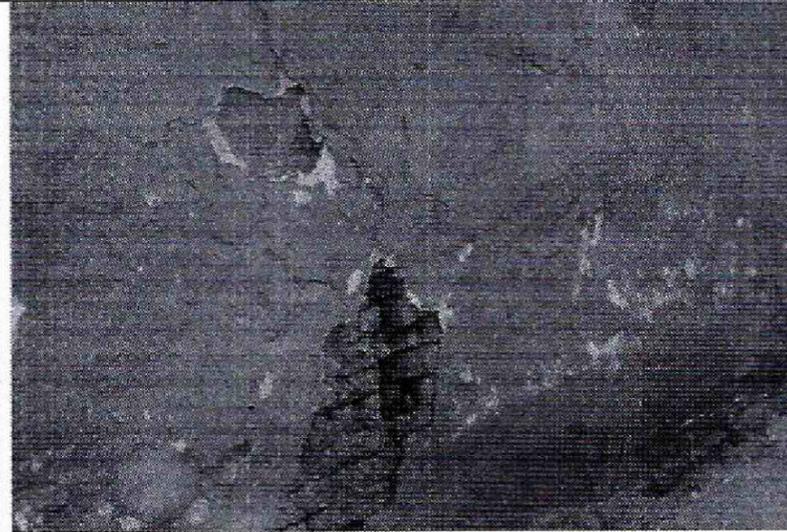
Daños en las unidades de adobe del muro de fachada del costado oriental.
